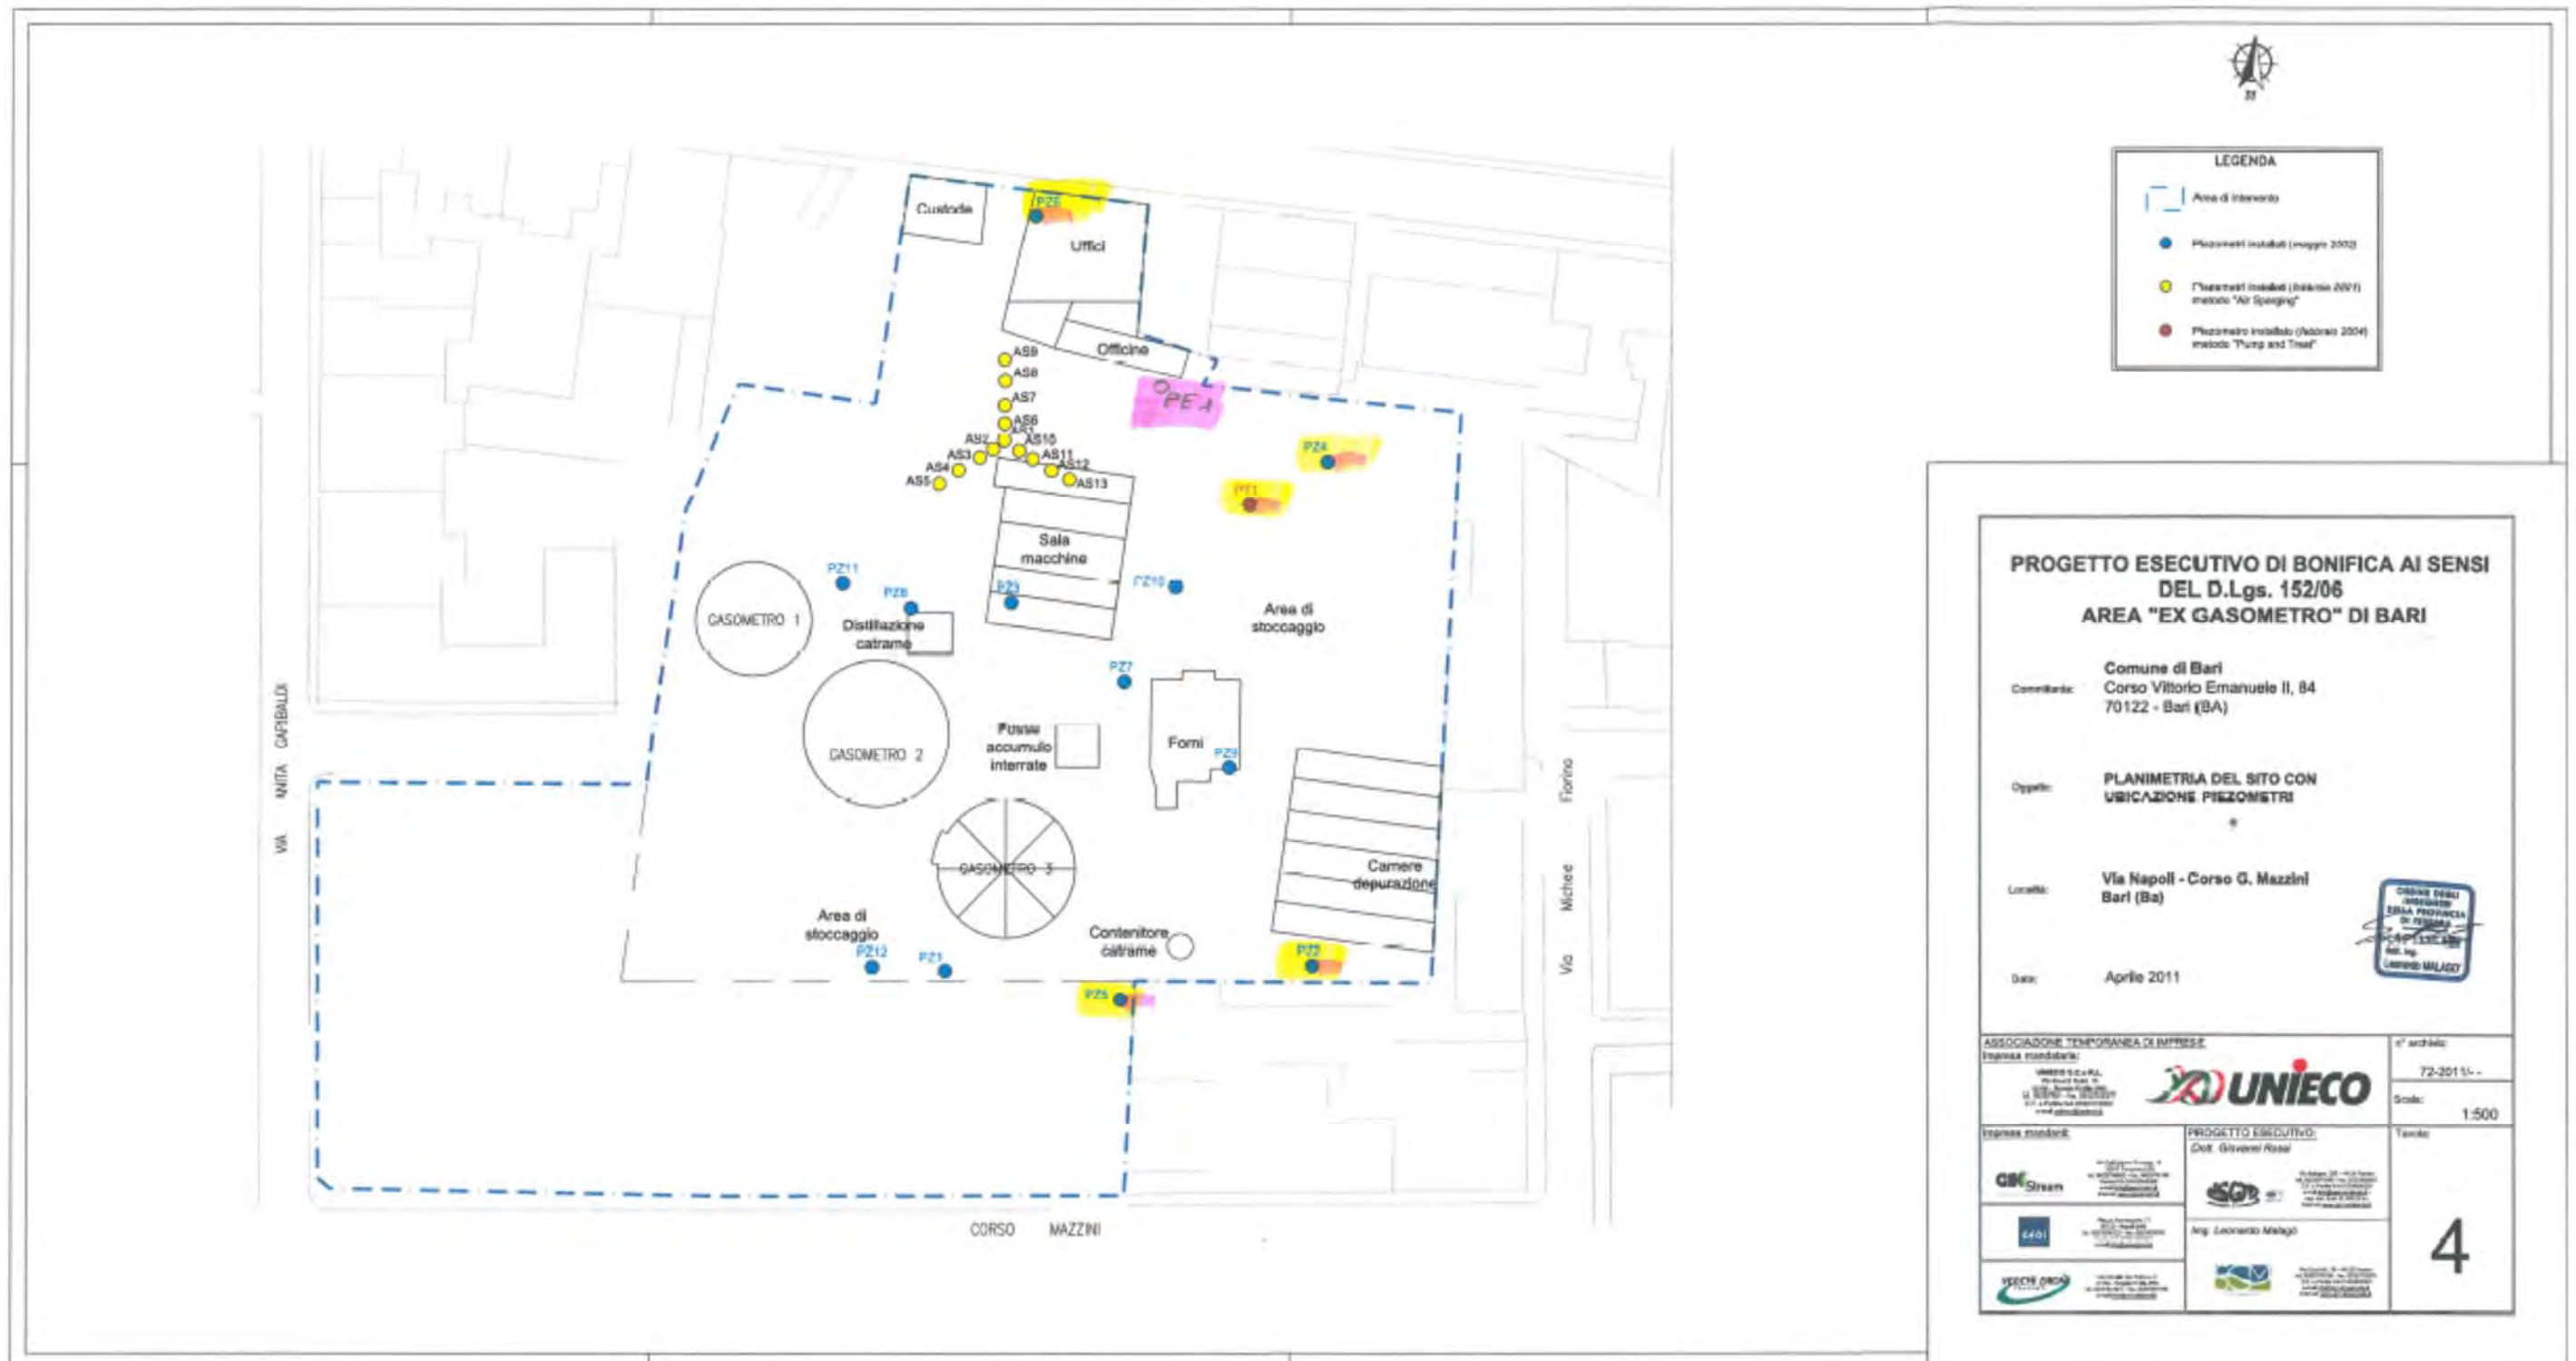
Planimetria area ex-Gasometro di Bari con ubicazione pozzi di emungimento e iniezione
